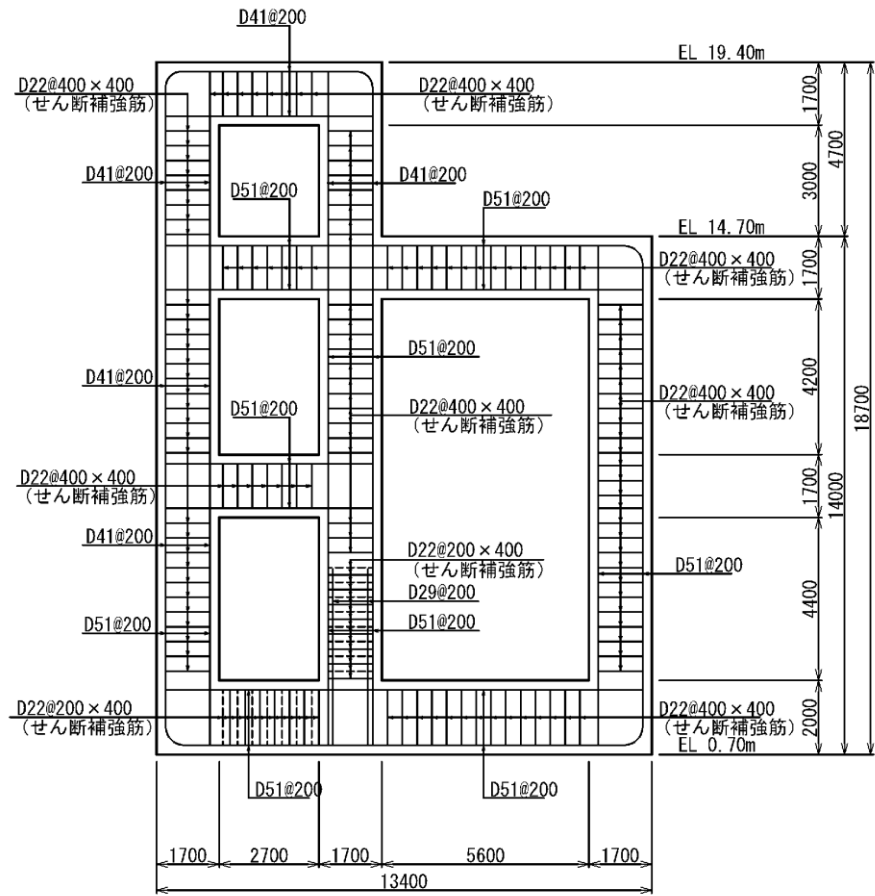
第 1 ベントフィルタ格納槽概略配筋図 (A-A 断面)
